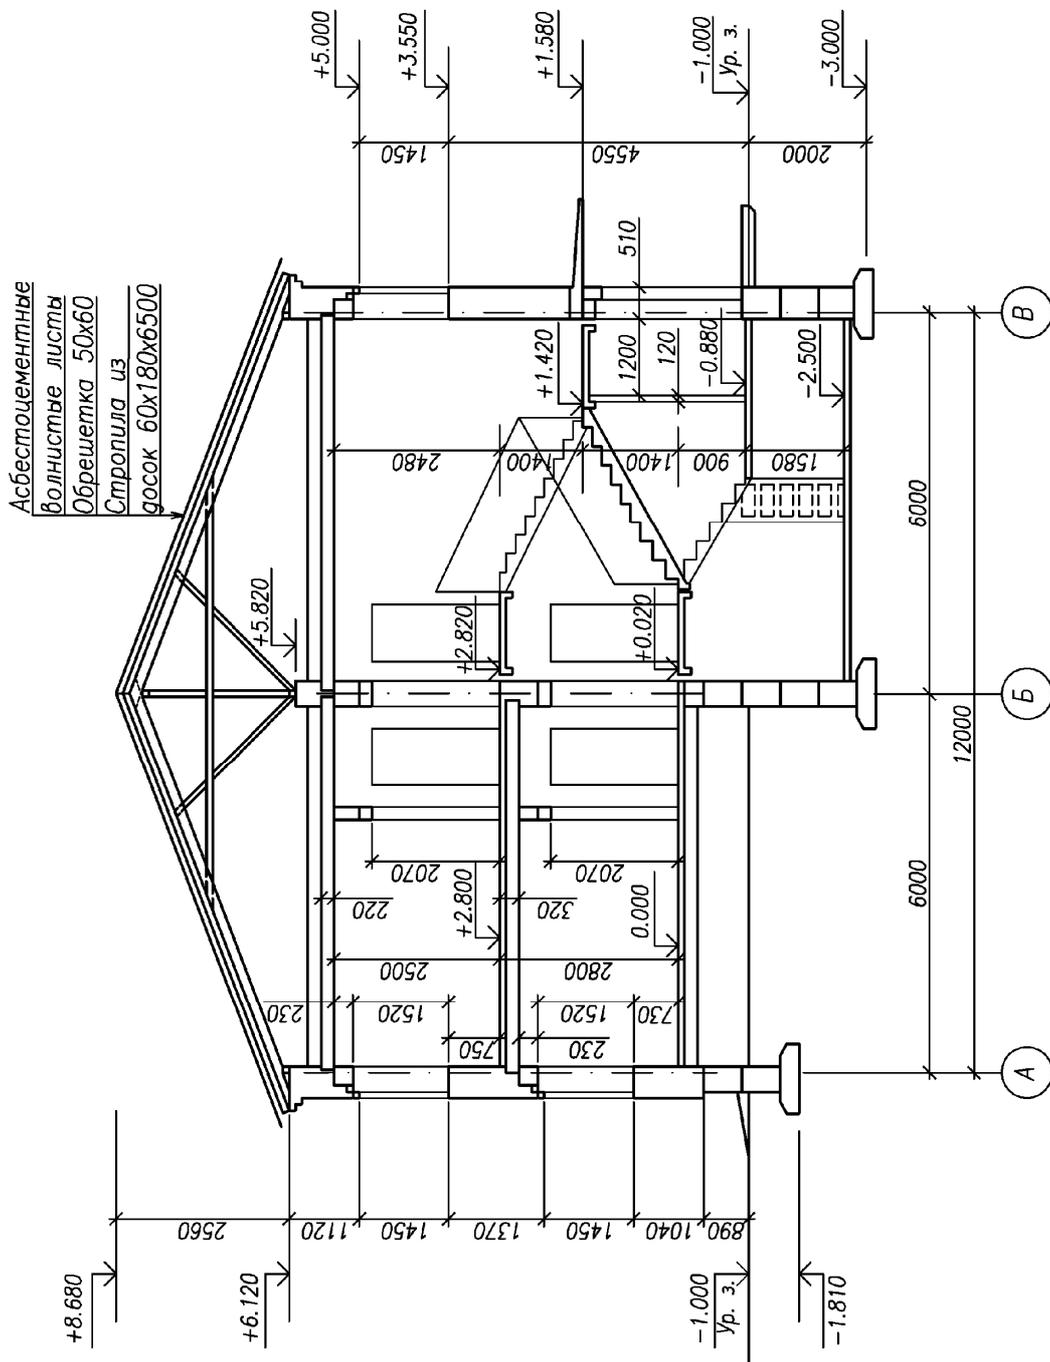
Поперечный разрез двухэтажного кирпичного дома
